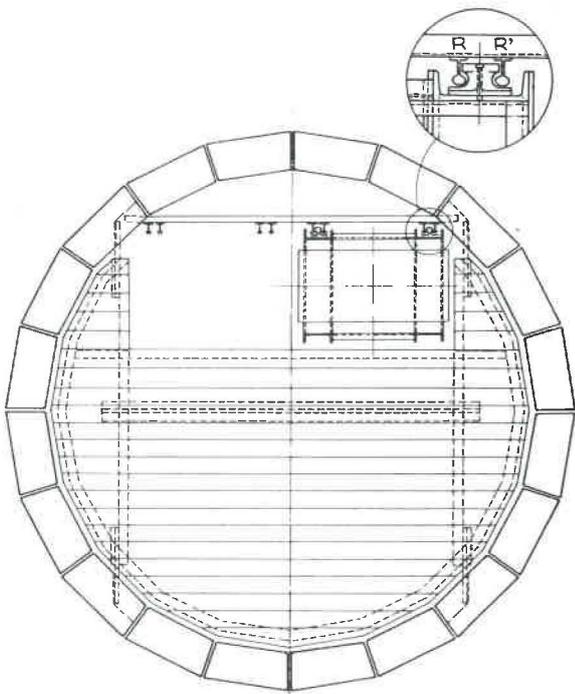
Coupe horizontale montrant les guidages doubles. En haut (en médaillon) vue d'une main courante symétrique qui peut ensermer simultanément les rails R et R'.
